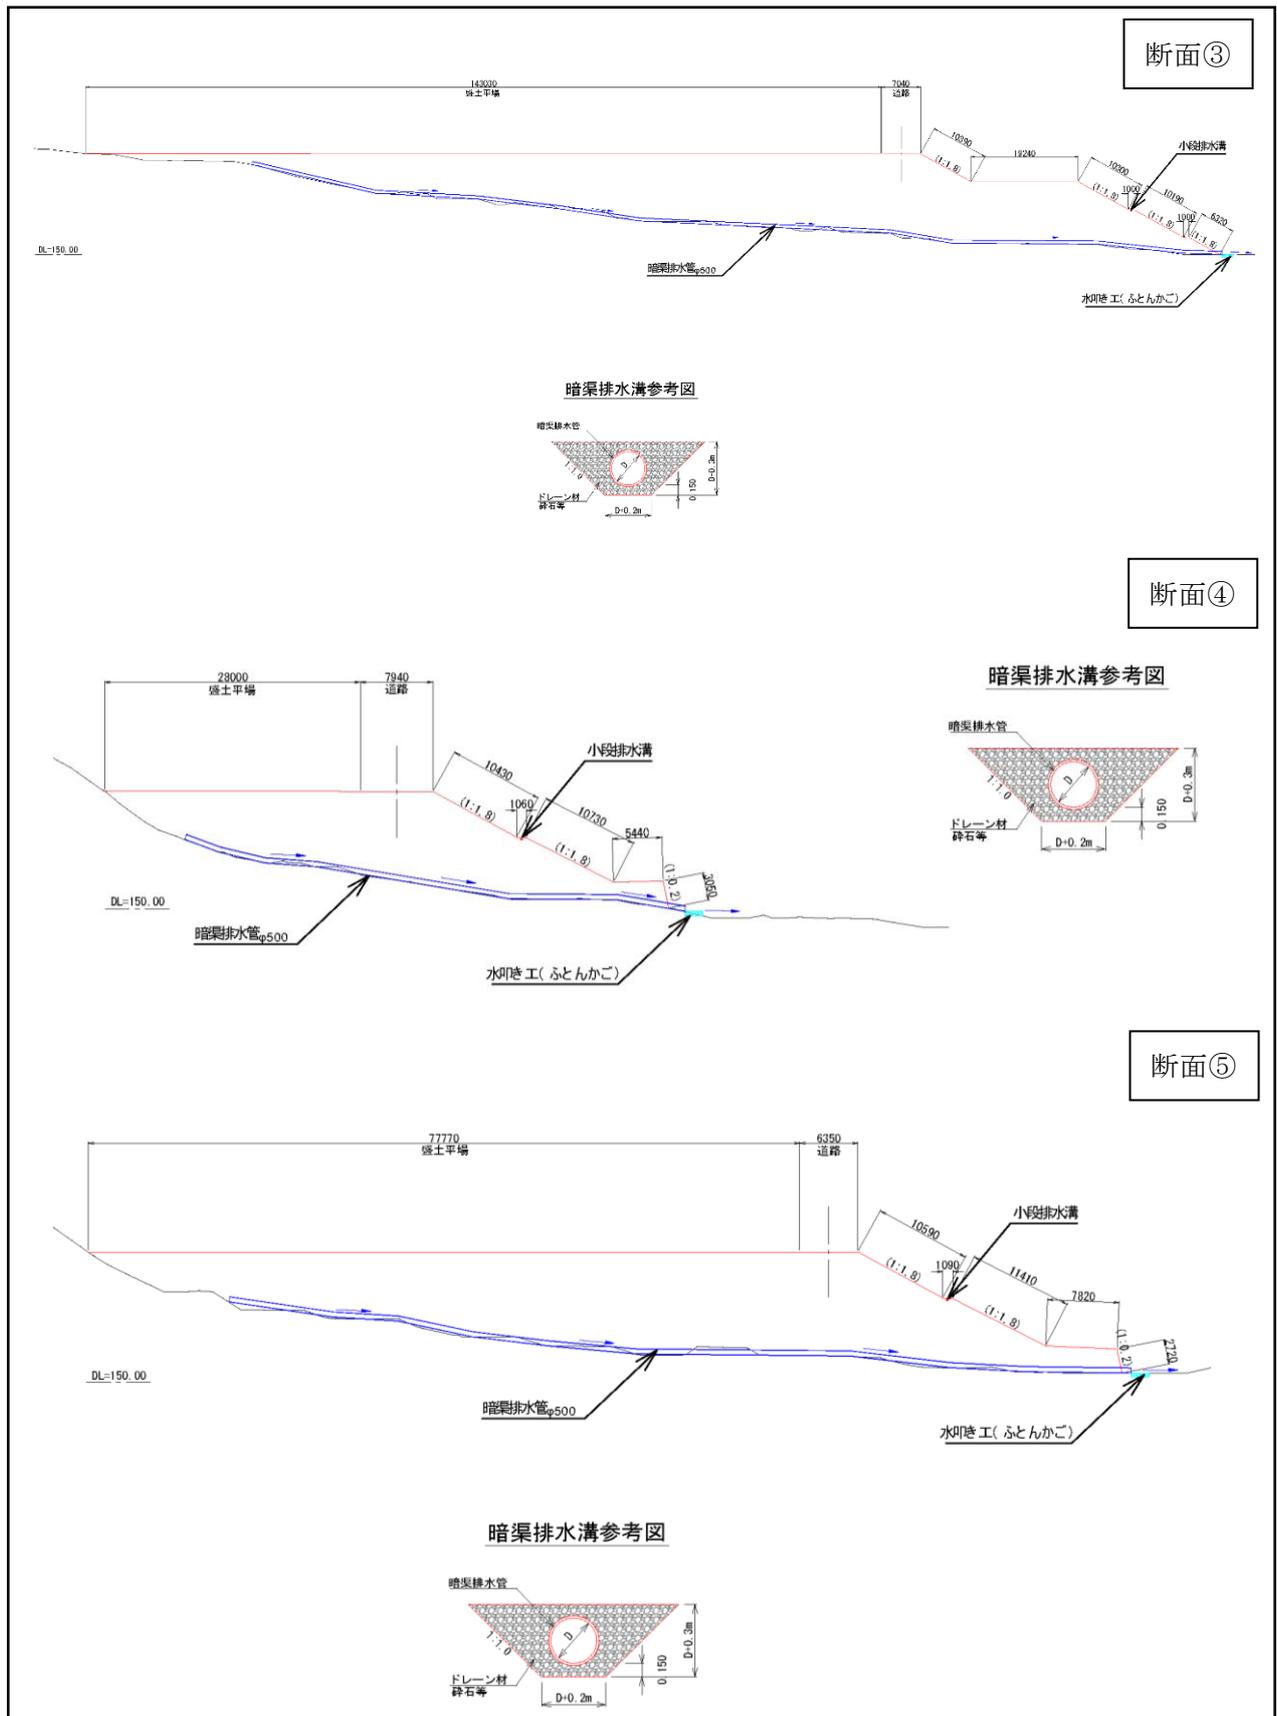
(3) 土捨て場及び排水溝の断面図
